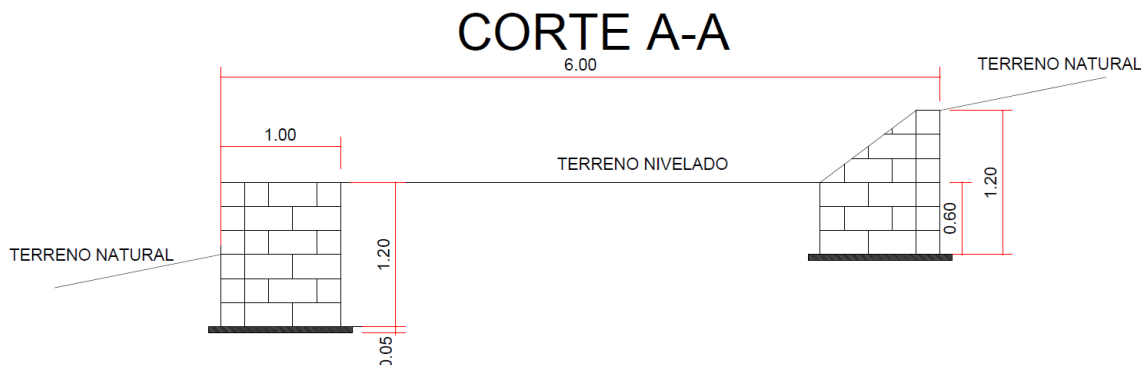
Corte esquemático A-A, com detalhe para o muro de arrimo a ser executado. Medidas em metros.
